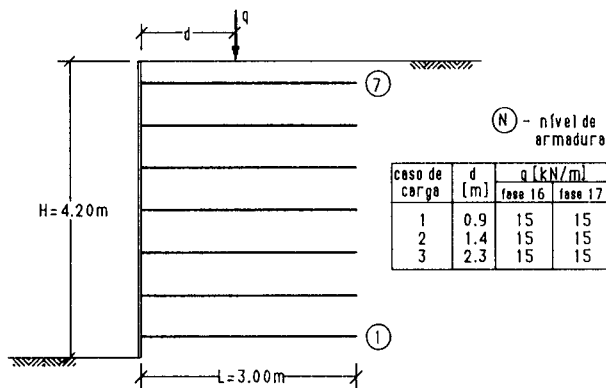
Geometria do muro de terra armada e localização da sobrecarga linear vertical
